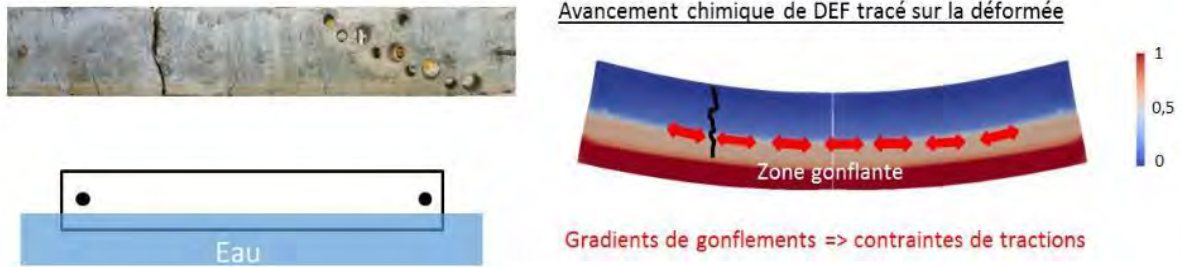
Rupture de la poutre non armée, photographie issue de (Martin 2010)
